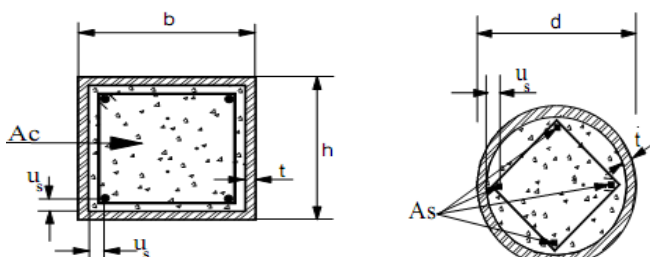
Seções transversais de pilares mistos preenchidos por concreto
